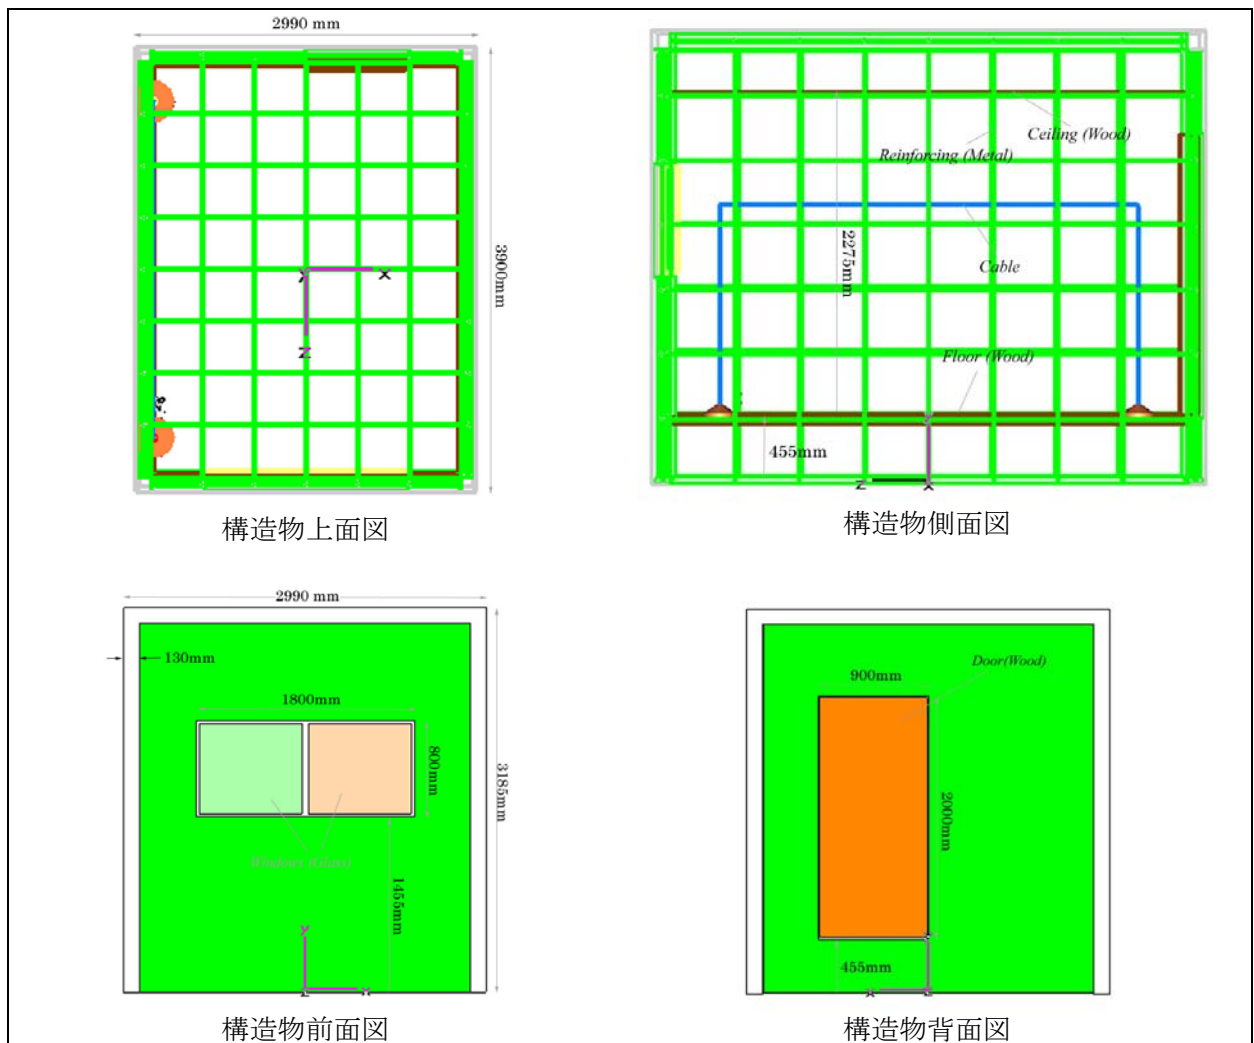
計算モデルの構造（鉄筋コンクリート構造物）
